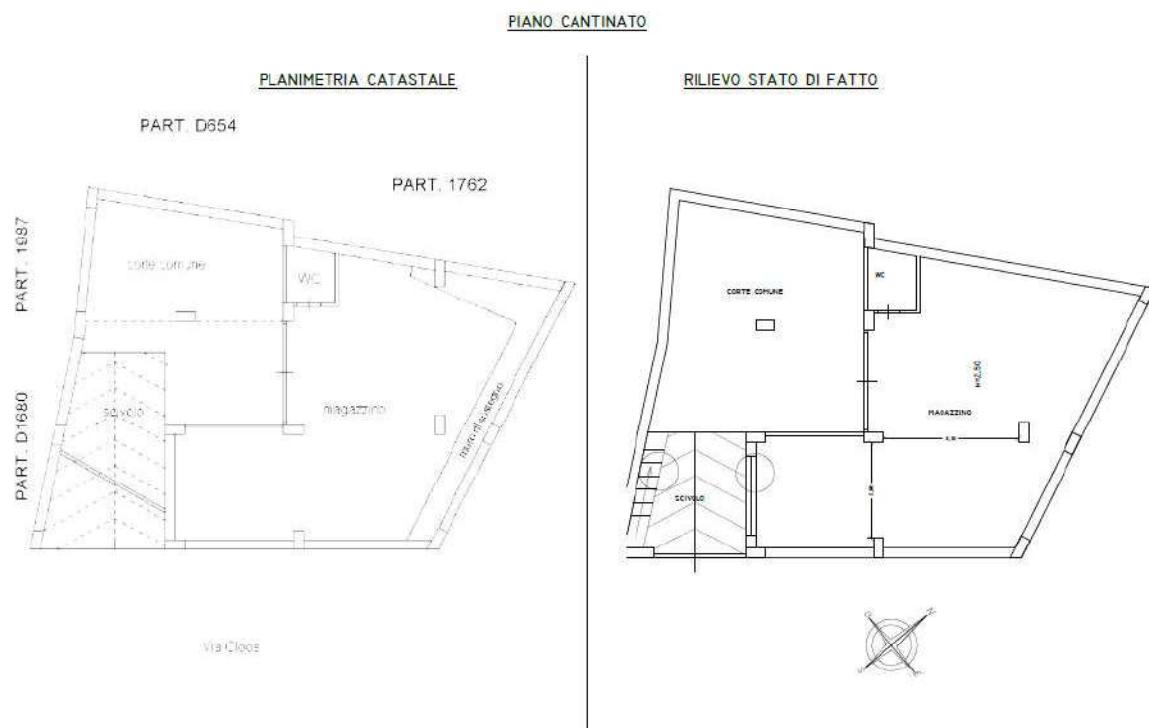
CONFORNTO PLANIMETRIA CATATSTALE CON STATO DI FATTO
